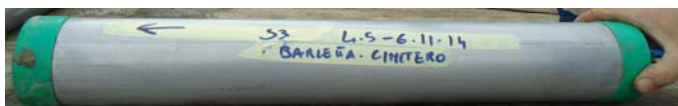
Campione indisturbato S3 prelevato nell'intervallo 4,5 m - Certificati in allegato dal N. 5637 al N. 5642
